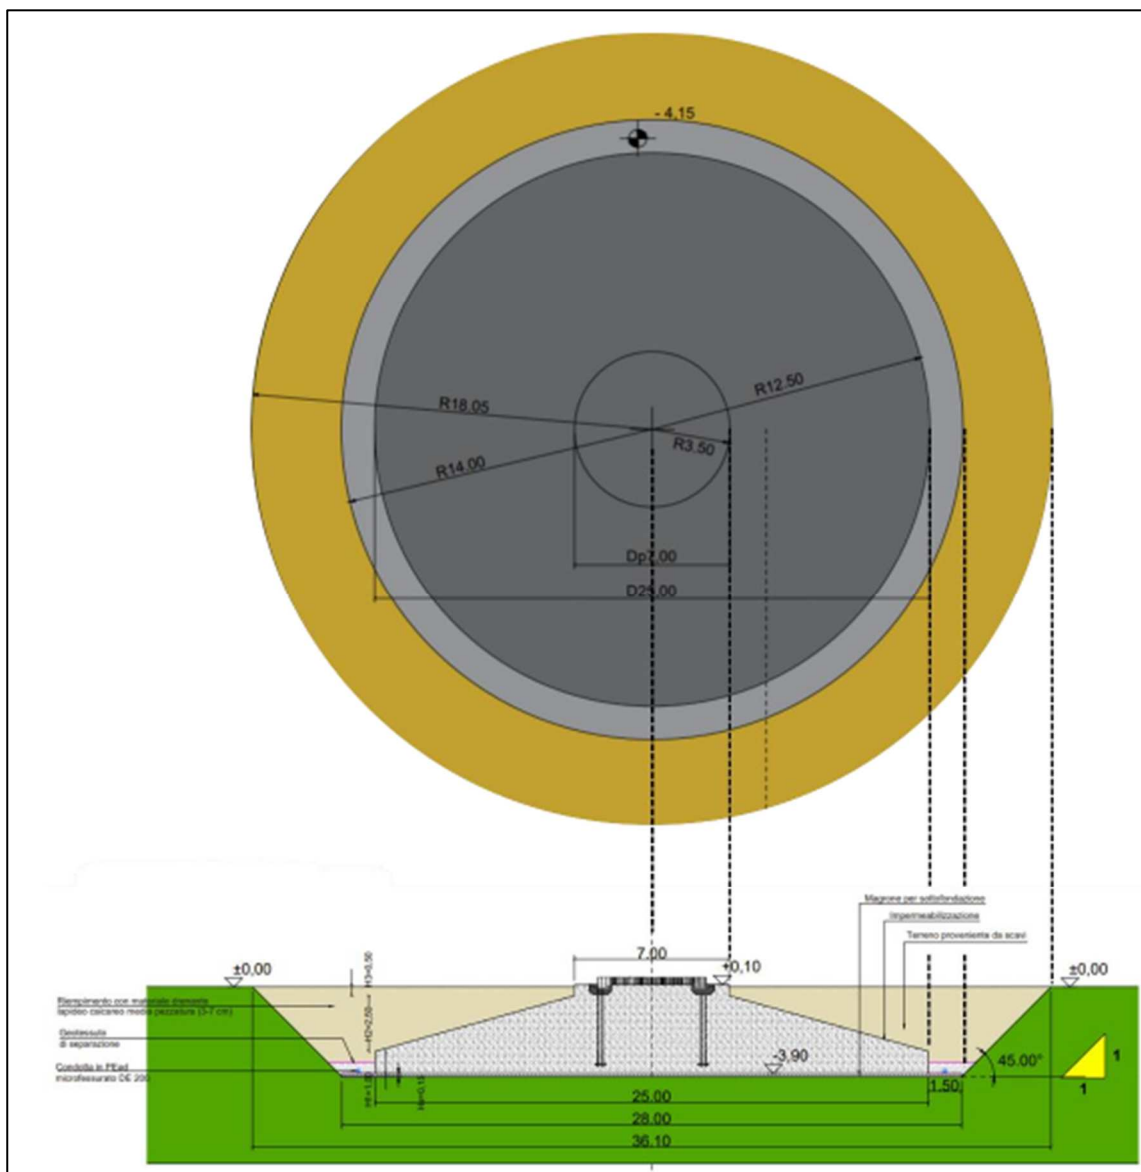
Pianta e vista della fondazione tipo dell'aerogeneratore
